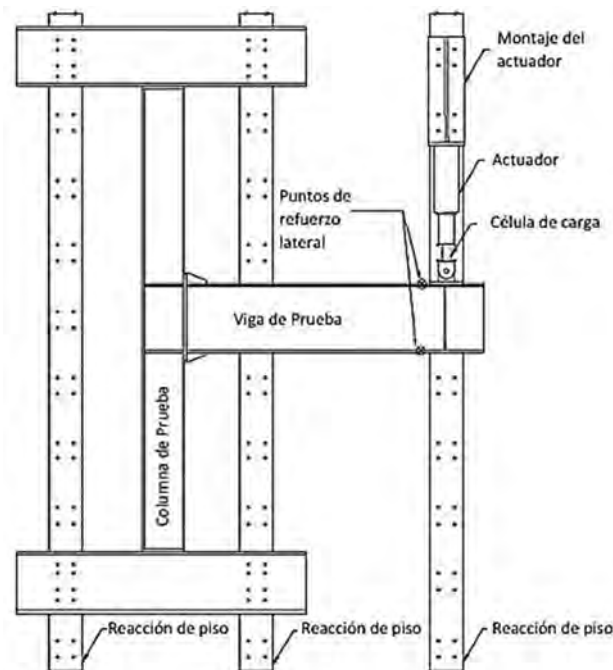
Vista en planta de la configuración de la prueba. Adaptada de Sumner (2003).
